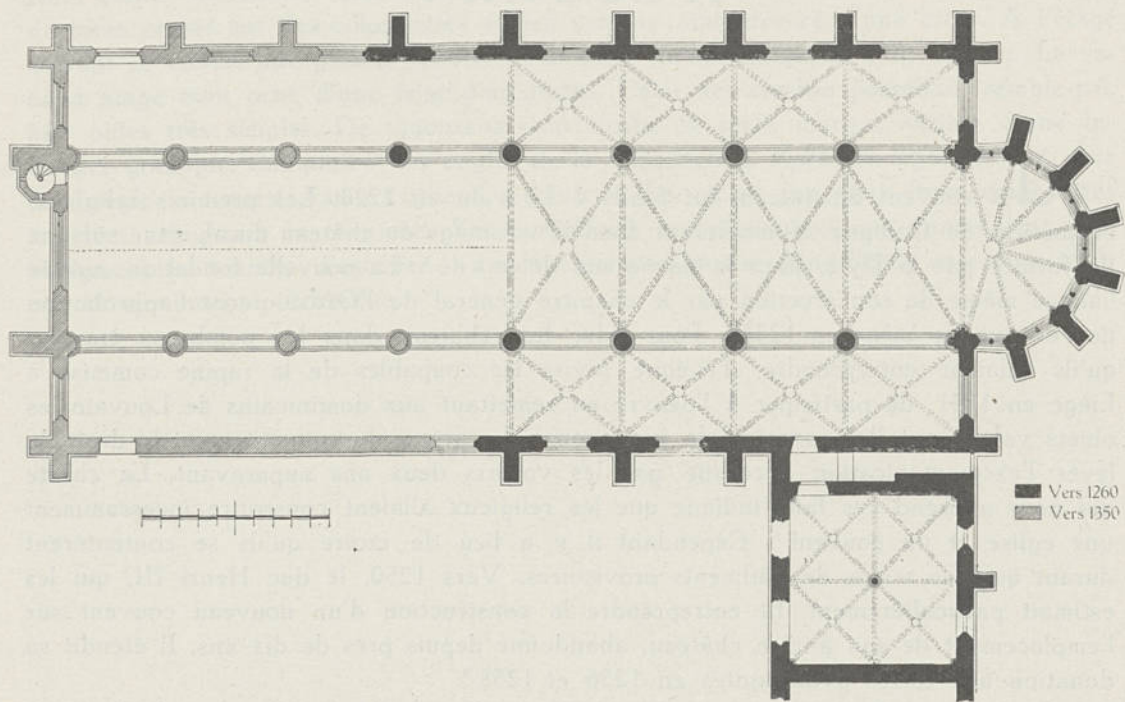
Louvain, Eglise Notre-Dame, plan terrier
